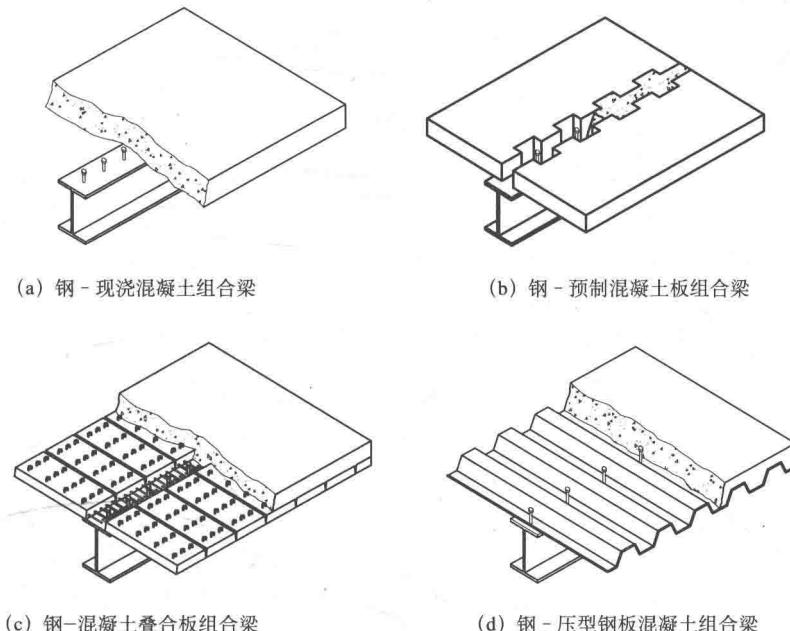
不同混凝土翼板的钢-混凝土组合梁截面形式
